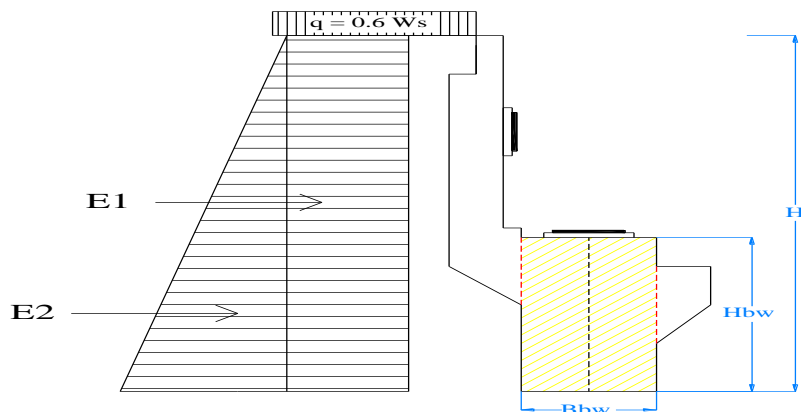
Penampang *Breast Wall Abutment* (arsiran kuning)
